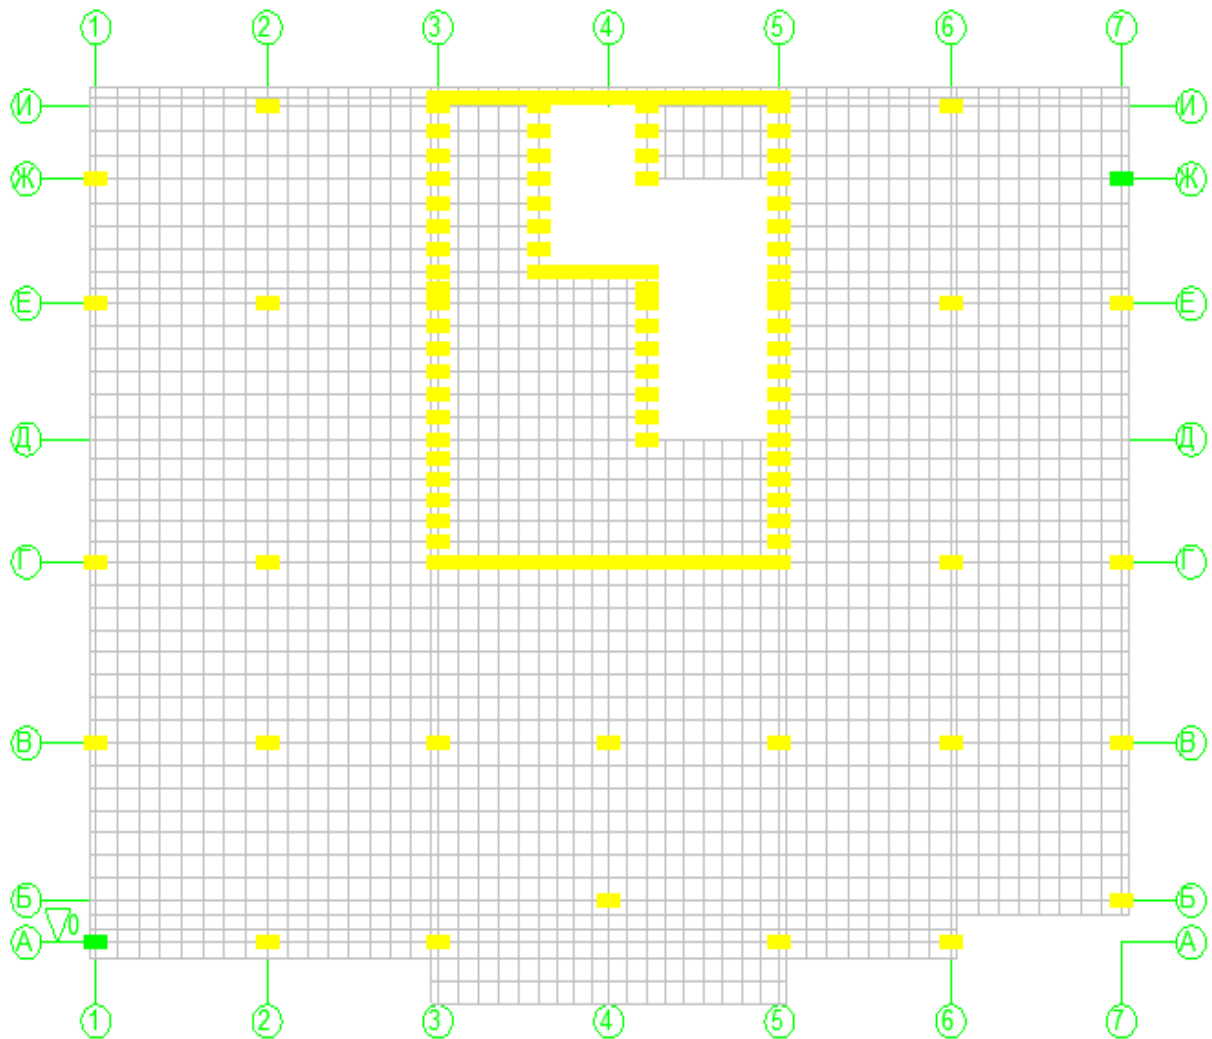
Результирующая расчетная схема плиты перекрытия
